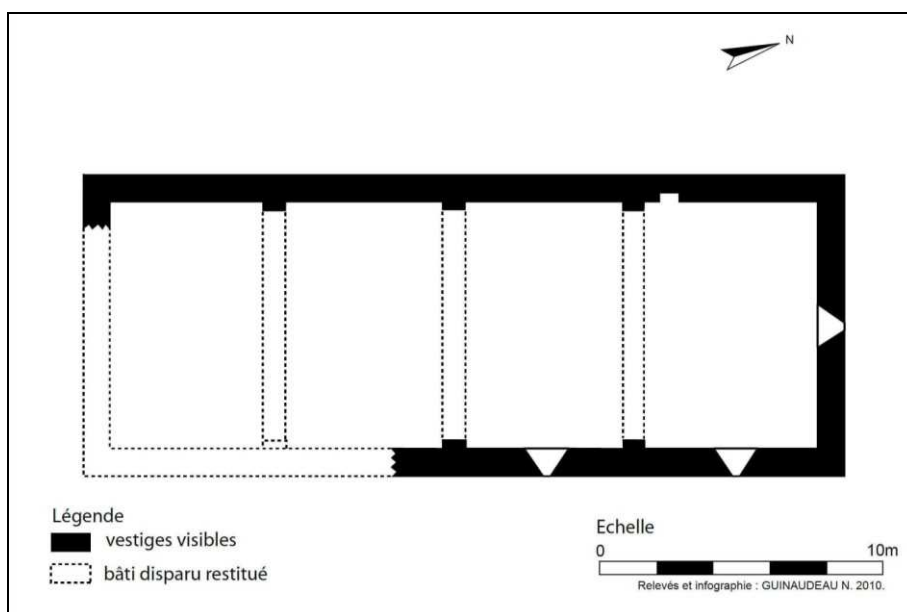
Plan au sol de la Salasse (commune de Barran).
